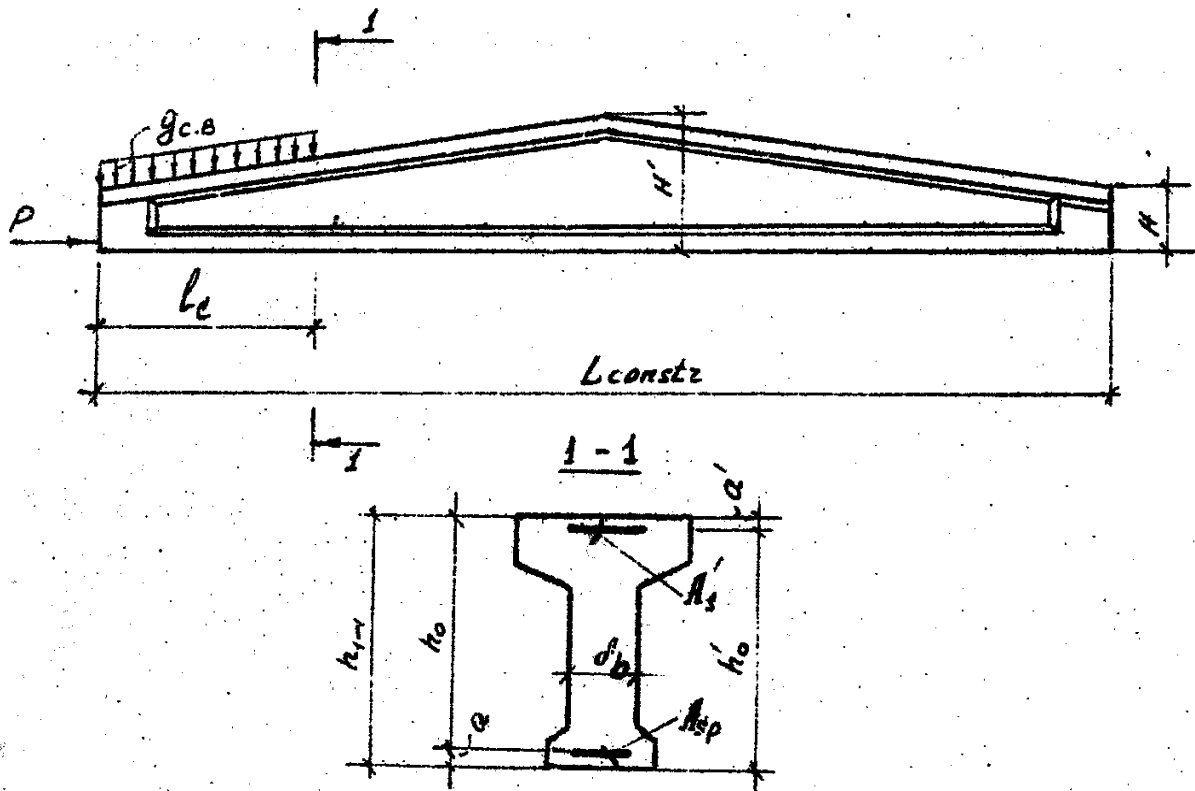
До розрахунку балки під час виготовлення, транспортування і монтажу
